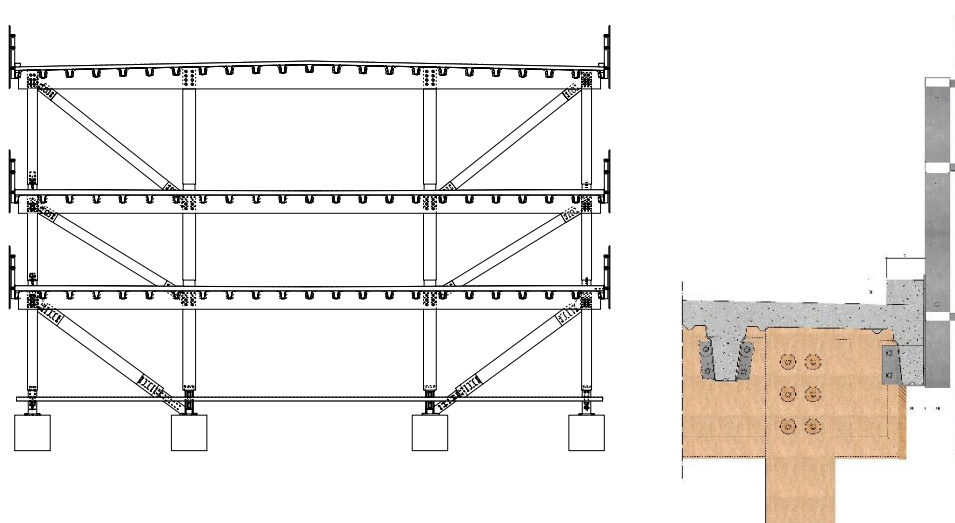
Coupe sur la structure et détail sur l'assemblage de la structure mixte
